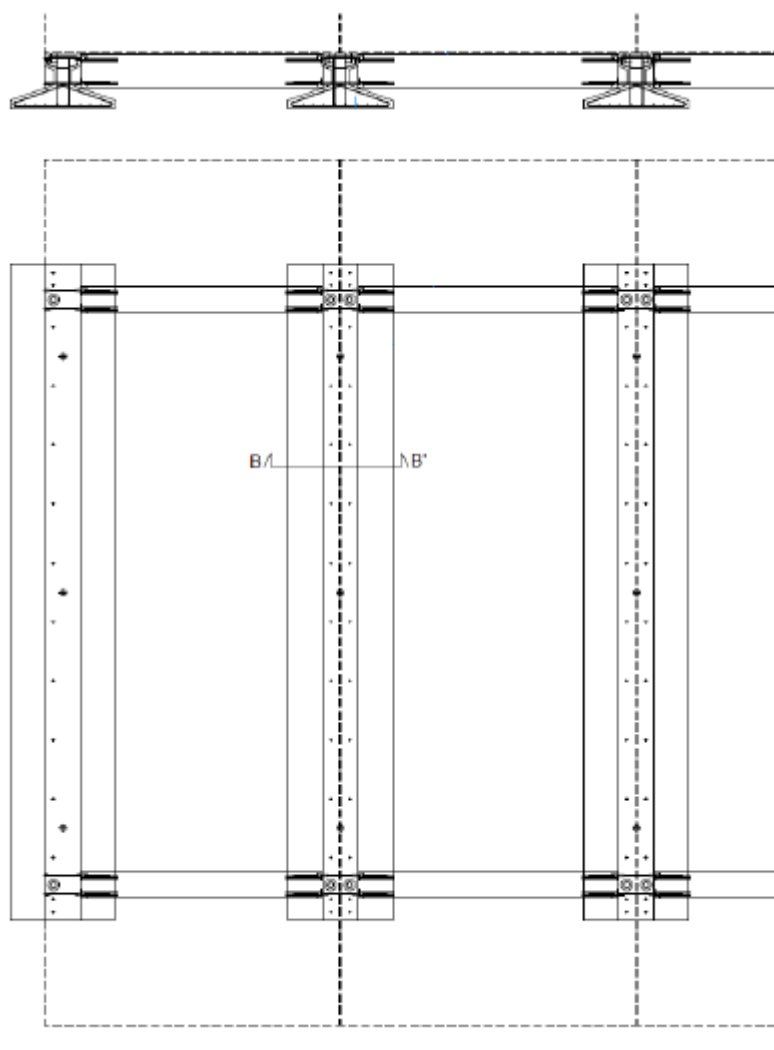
Vista general de la cimentación de un edificio basado en elementos de cimentación prefabricada Compact Habit®.
